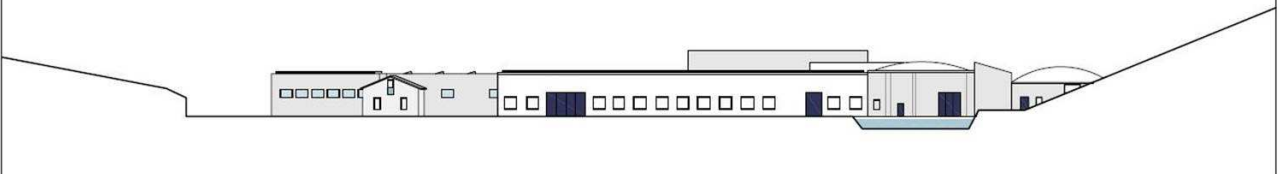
Stralcio elaborato di progetto Tav. 1 Stato di fatto ditta LAMPLAST
